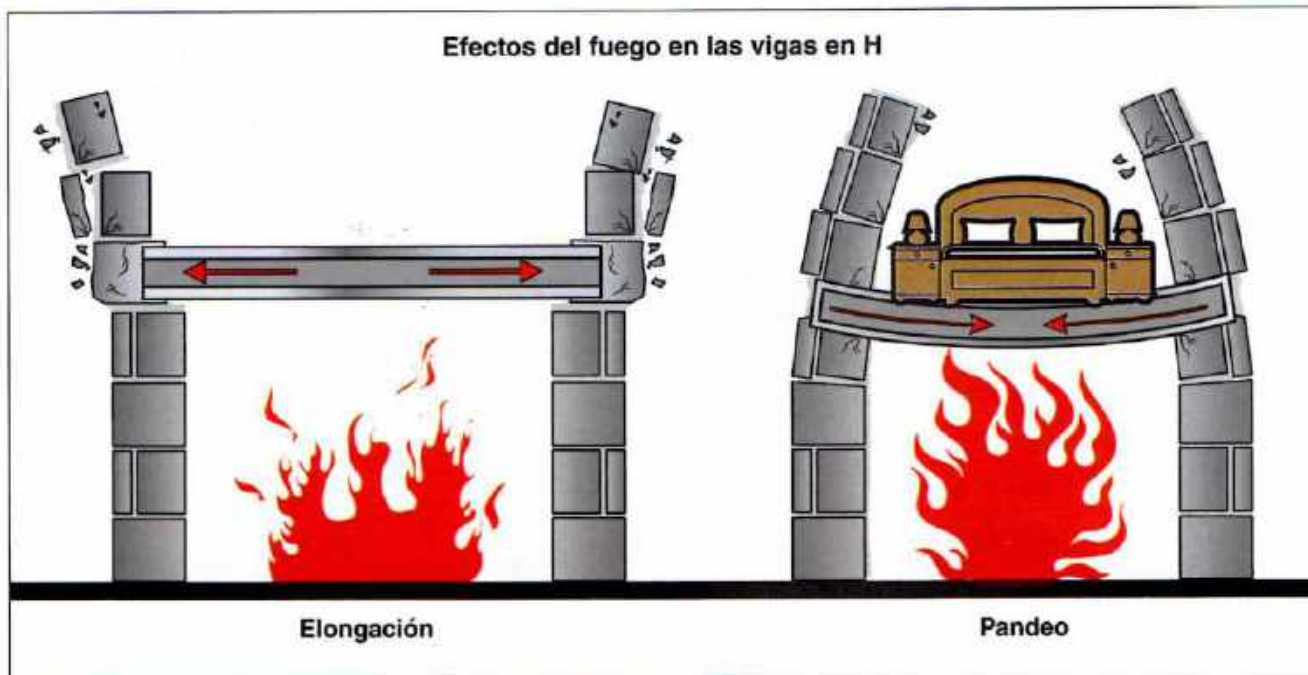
El calor puede hacer que los elementos estructurales de acero se alarguen o fallen según las condiciones del incendio, la construcción de la edificación y la ubicación del contenido.
